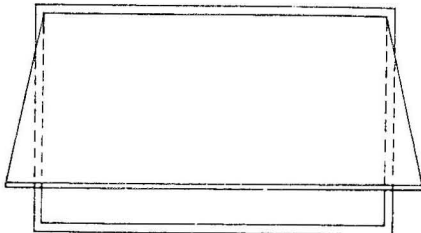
Fenêtre à vantail sur axe horizontal supérieur (ouvrante vers l'intérieur)
